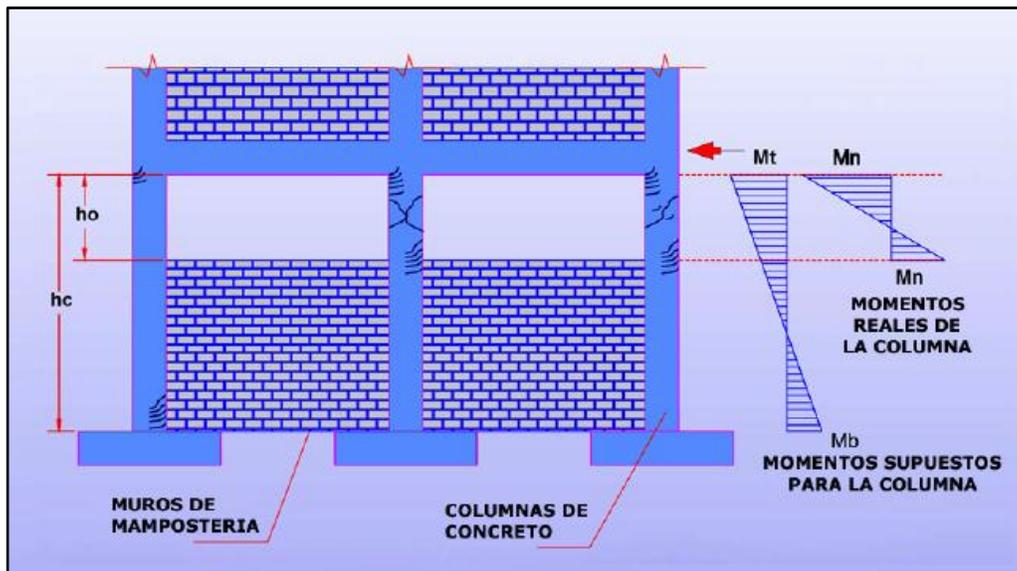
Interacción de muros de mampostería con marco de concreto generando fallas por columnas corta.
